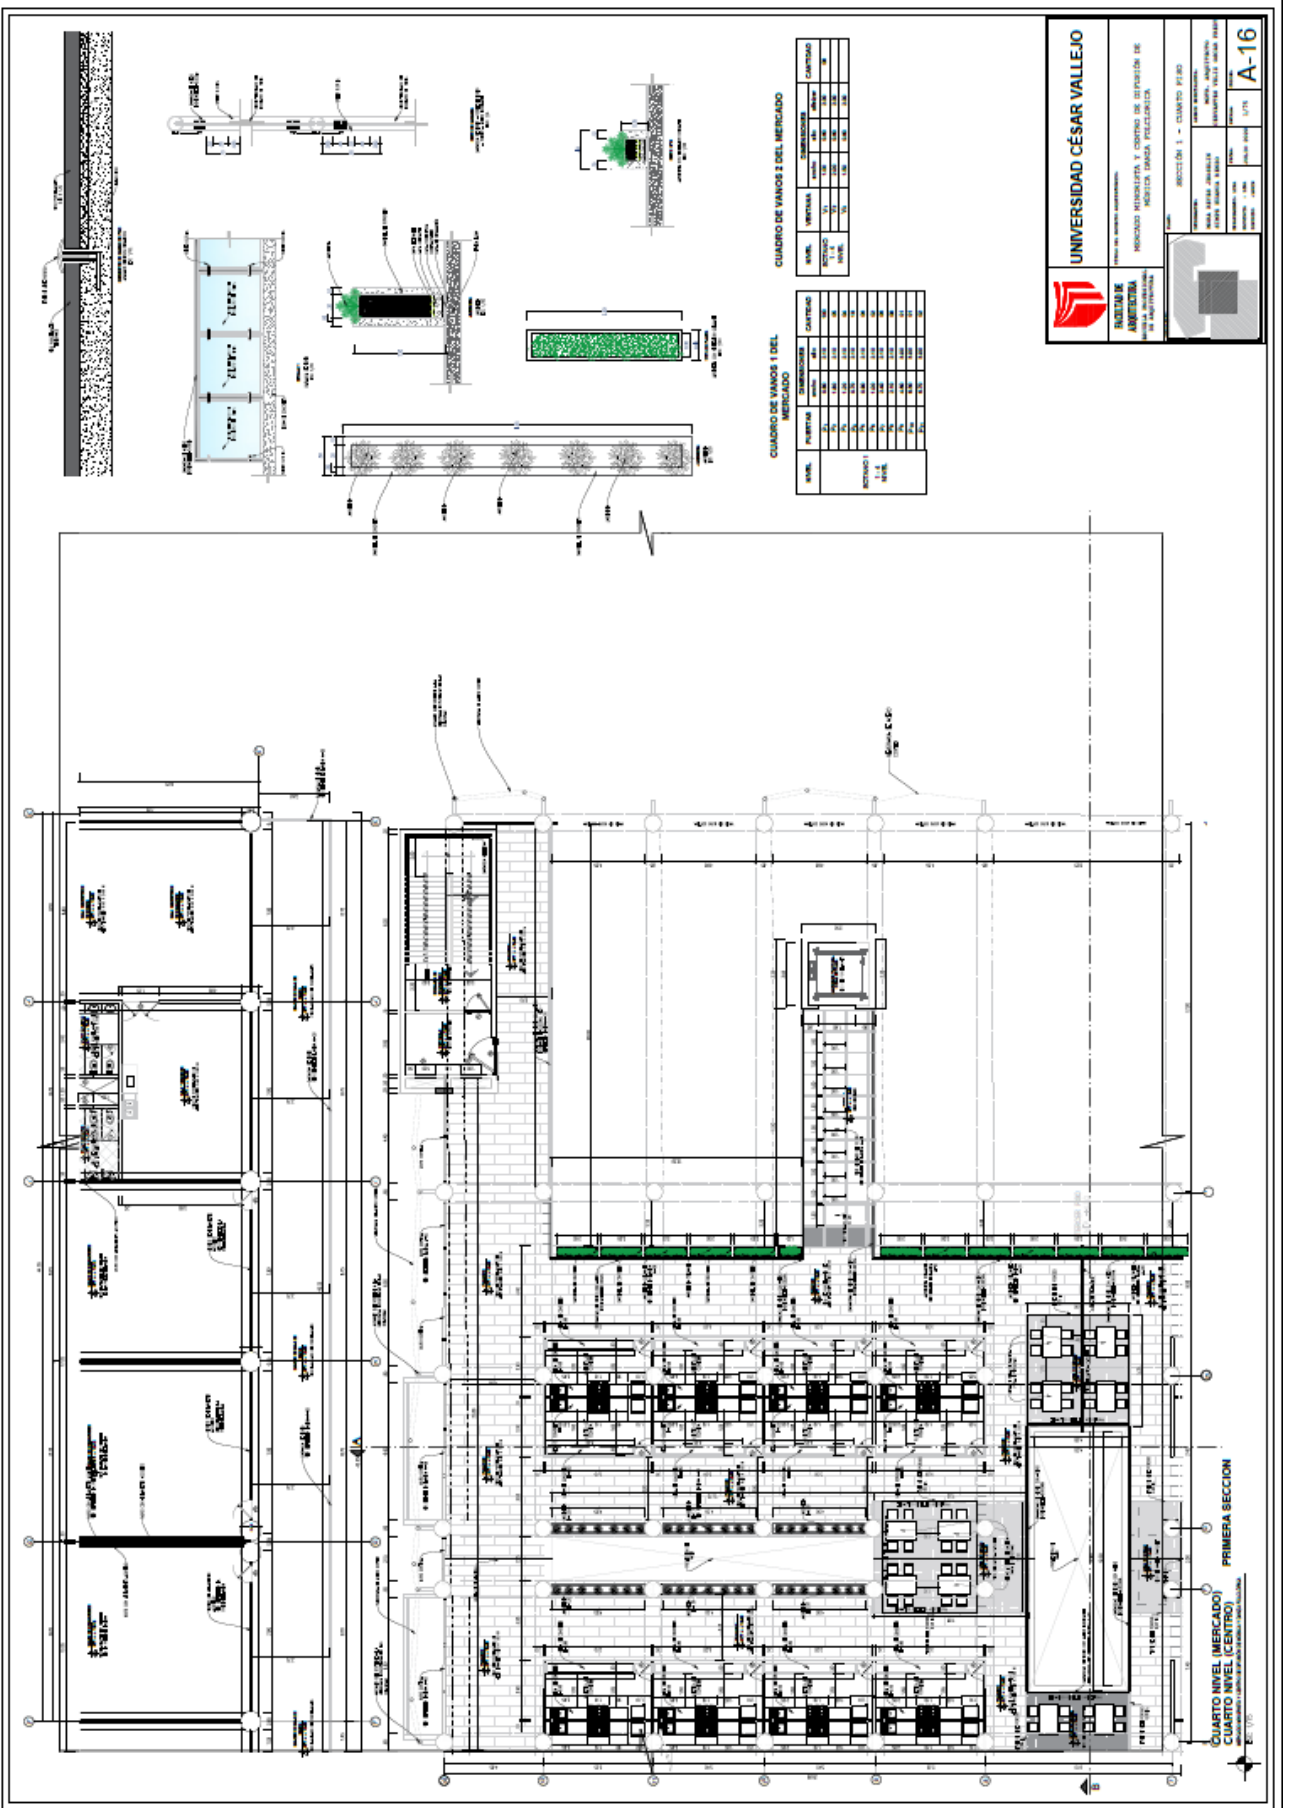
Plano de Cuarto Nivel Mercado - Proyecto
